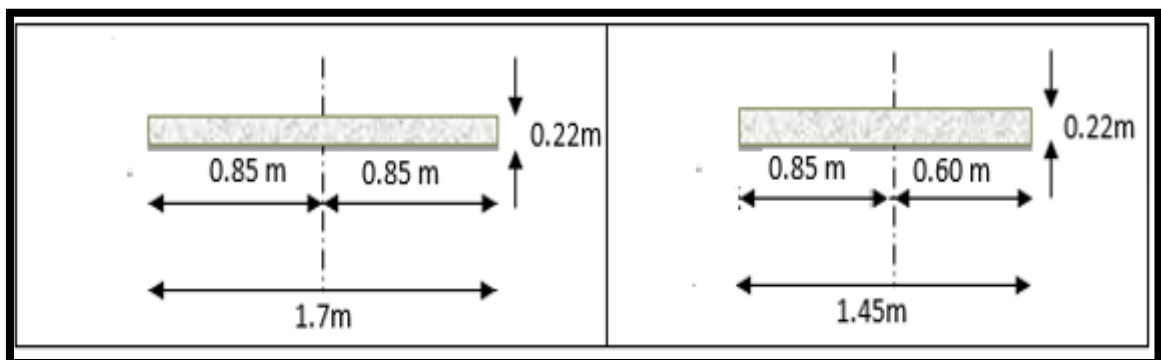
Section de hourdis revenant à une poutre Intermédiaire.
